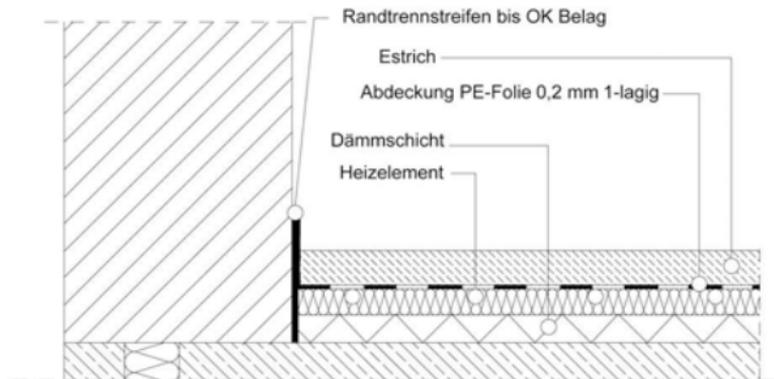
Heizestrich – Bauart B (Quelle: Hallschmid)
